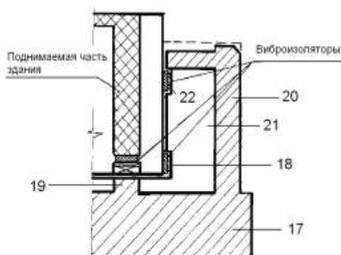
Схема виброизоляции цокольного этажа в основании здания.
